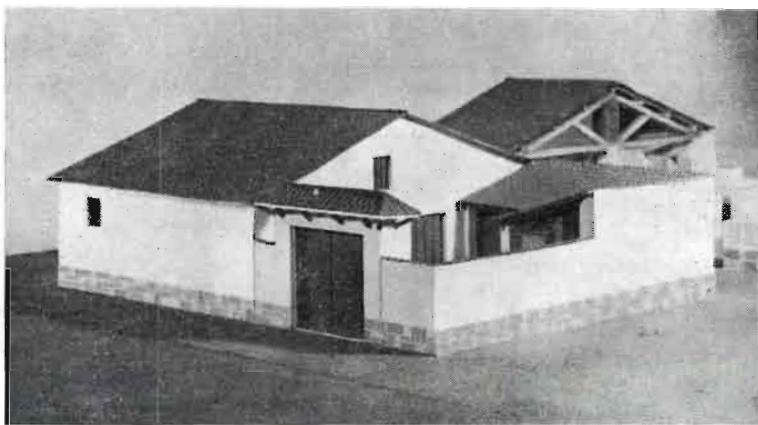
La cercha a la española se emplea con gran frecuencia en las construcciones rurales. (Foto I. N. C.)
